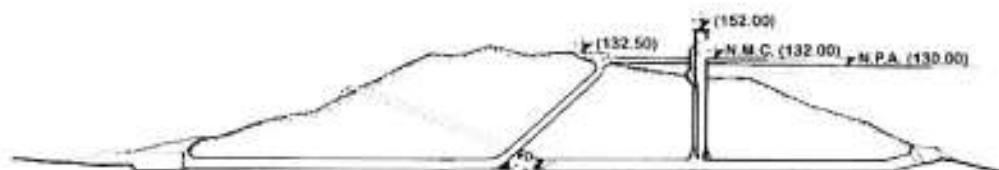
Descarregador de cheias da barragem do Santa Clara (Fonte: portal INAG – Barragens de Portugal)
